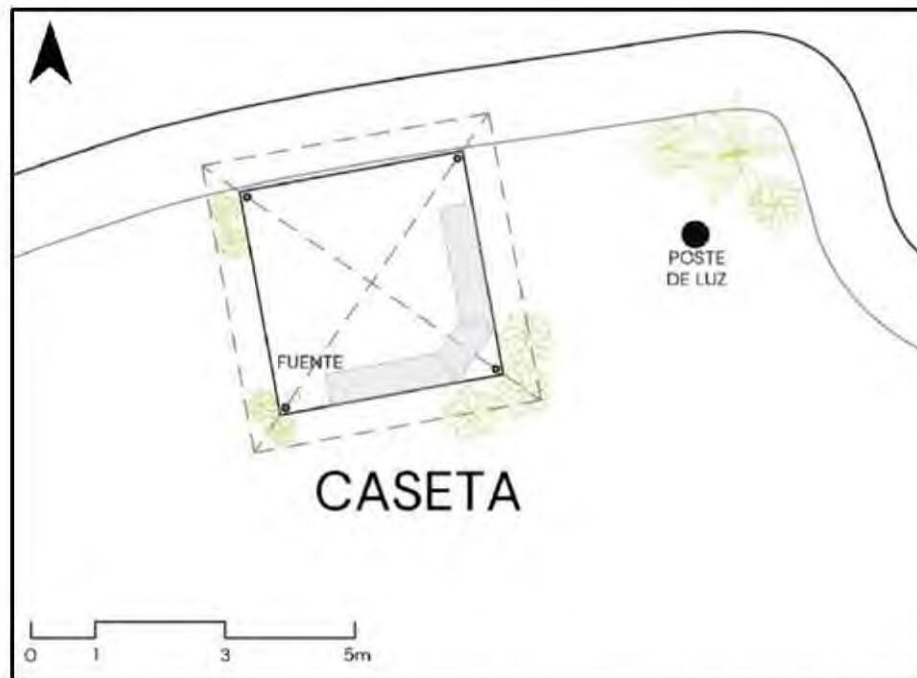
Planta arquitectónica de caseta. Fuente: Autoría propia
